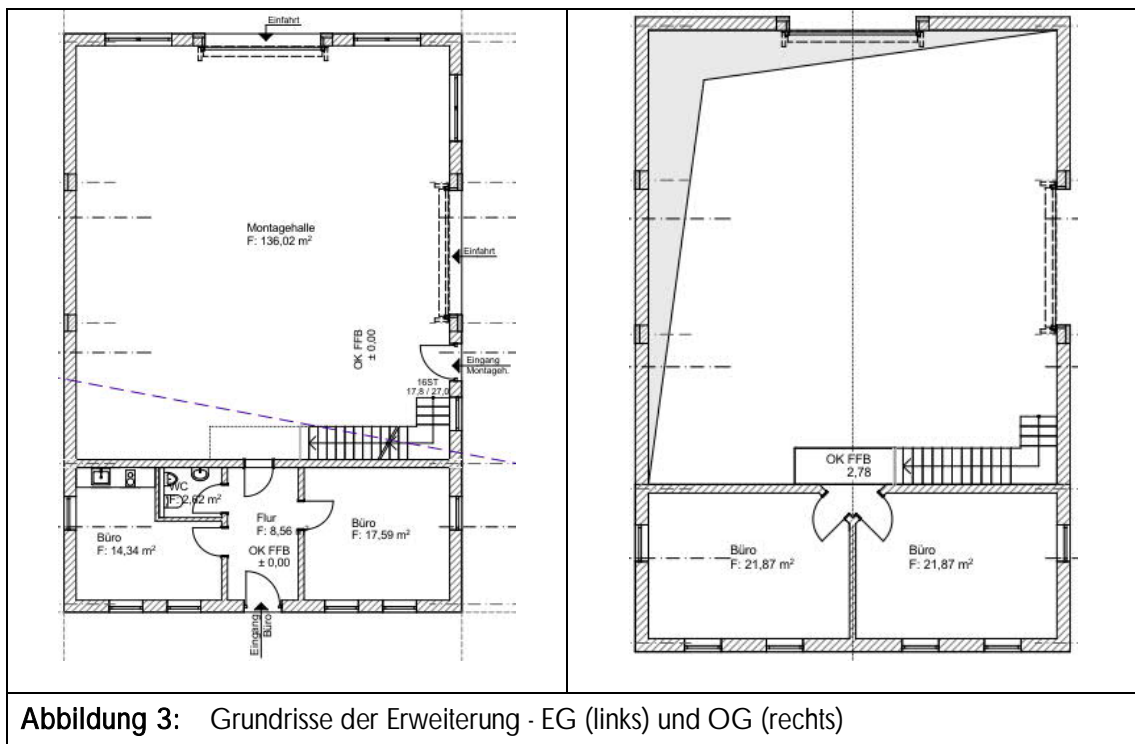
Grundrisse der Erweiterung - EG (links) und OG (rechts)
